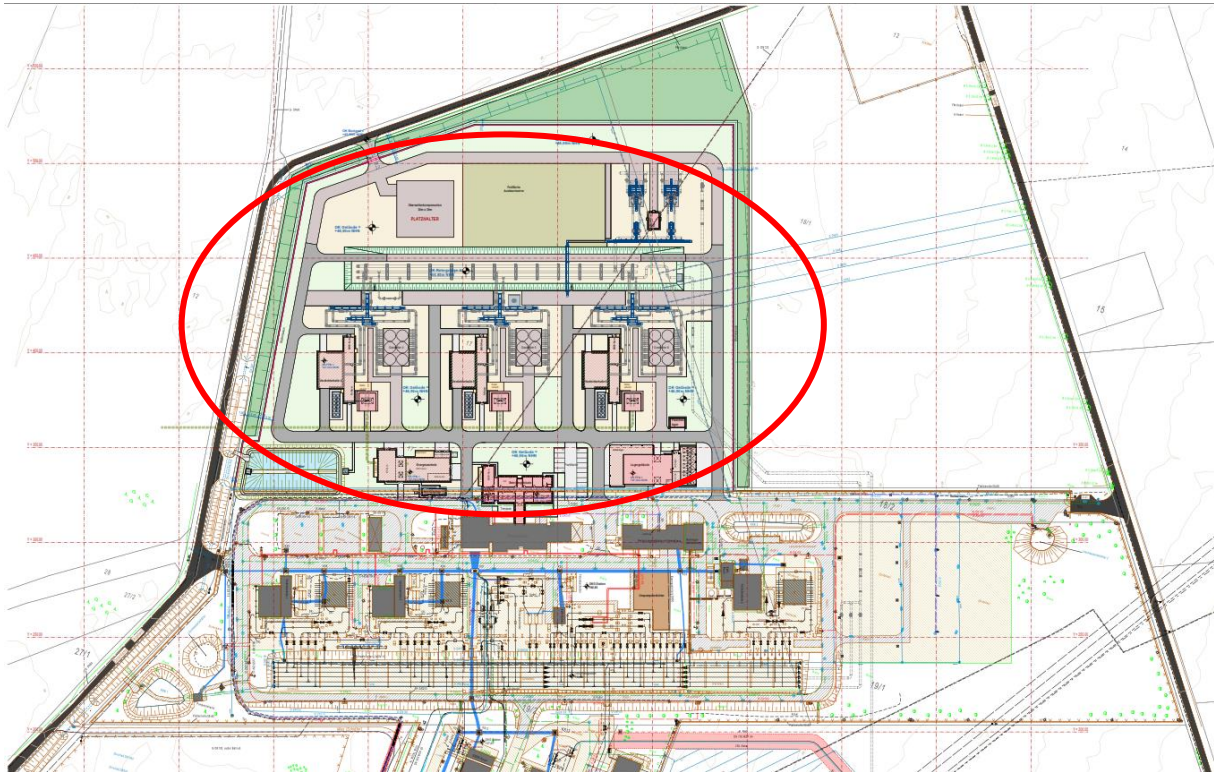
Lageplan mit Erweiterungsfläche /3.17/
